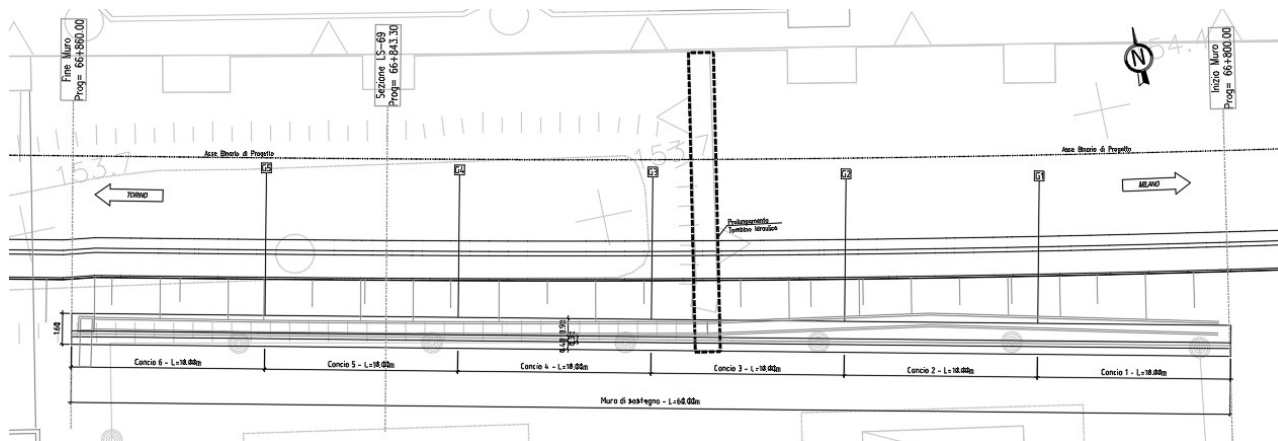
Planimetria generale dell' opera – Muro di sostegno di linea
